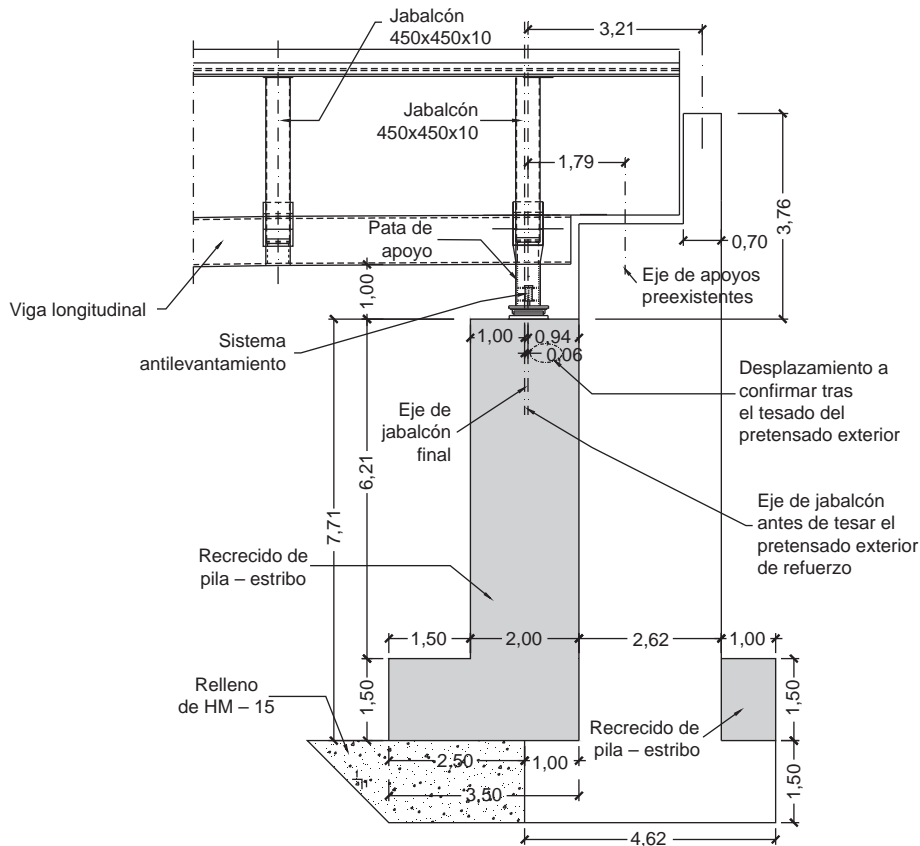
Alzado lateral de la ampliación de la pila-estribo, lado Galicia.
